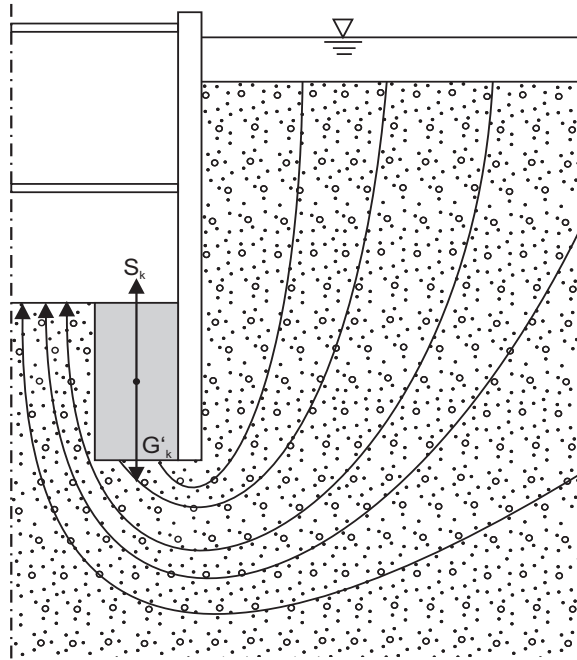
Nachweis gegen hydraulischen Grundbruch im Grenzzustand HYD
